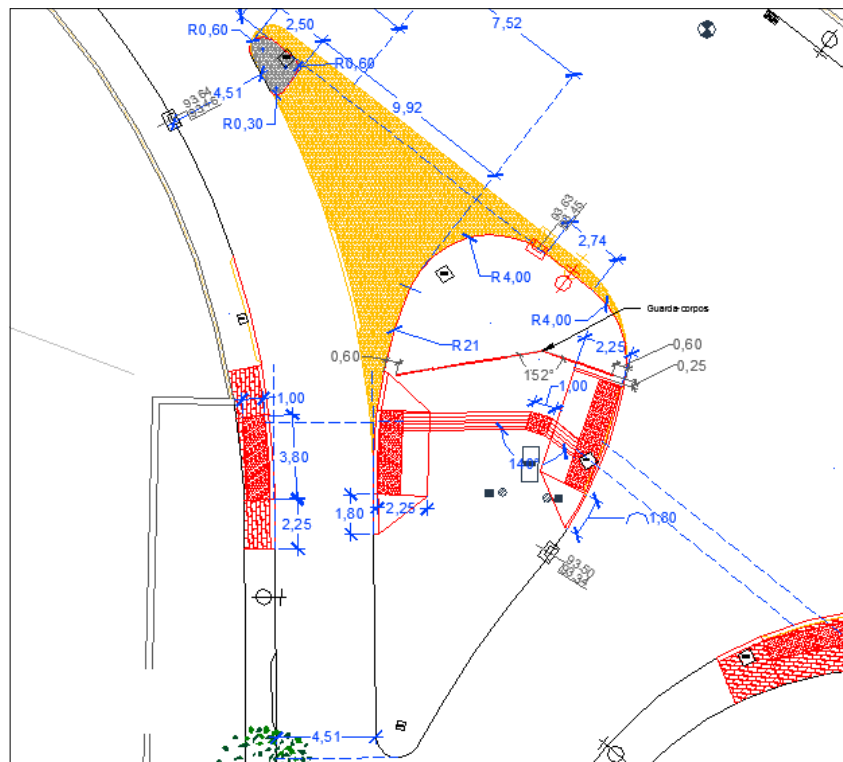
Pormenor da primeira versão do projeto base de alterações à geometria.
